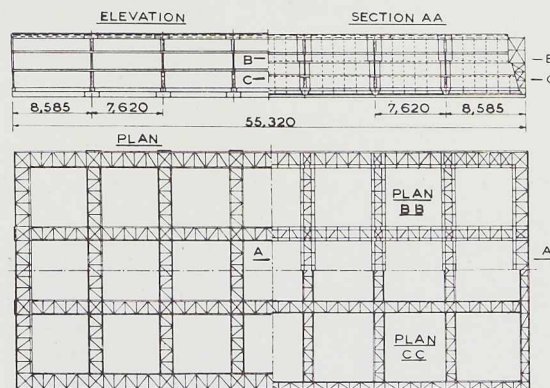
Charpente métallique des piles, qui fut descendue dans le sol à la façon d'un caisson à trousse coupante.
